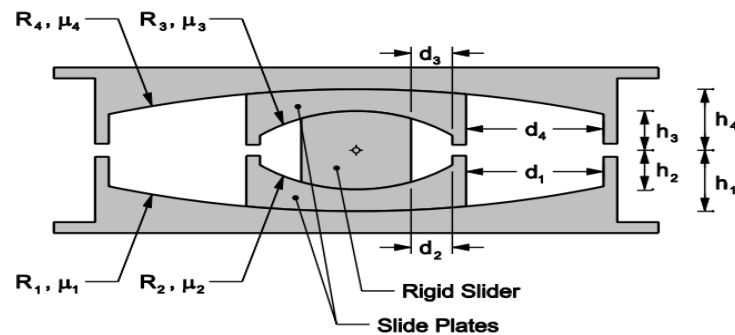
Sección Transversal del Aislador Triple Péndulo Fricción y Definición de Parámetros (Fenz D. & Constantinou M., 2008).
